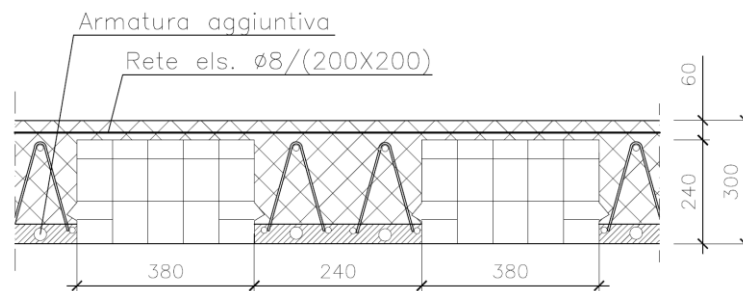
Dettaglio nuovo solaio tipo Bausta.
